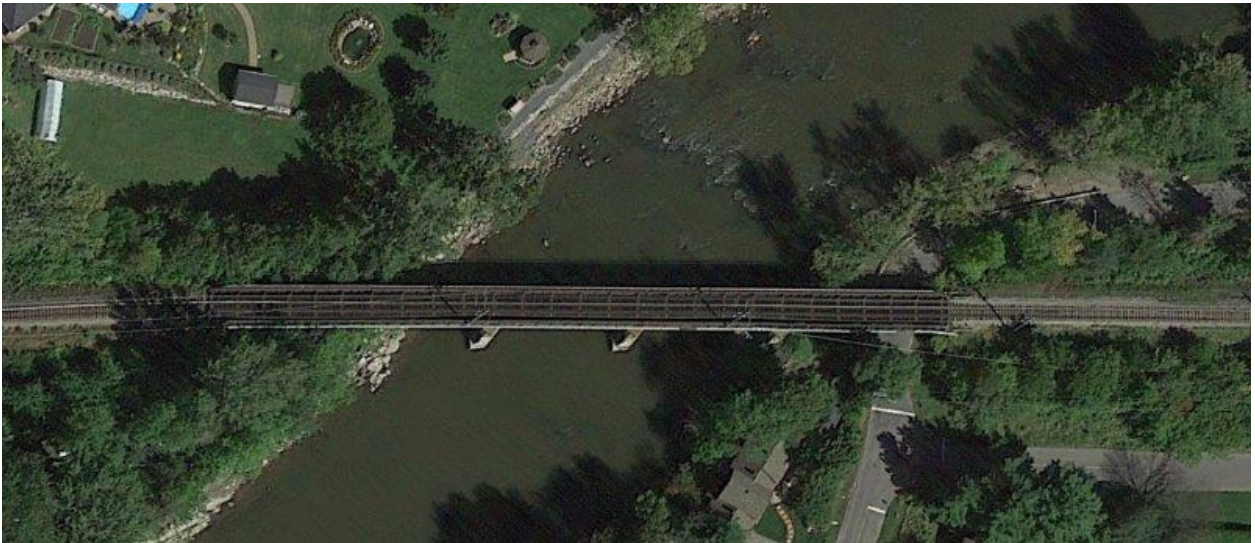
Section 1 - Pont de la rivière des Prairies
